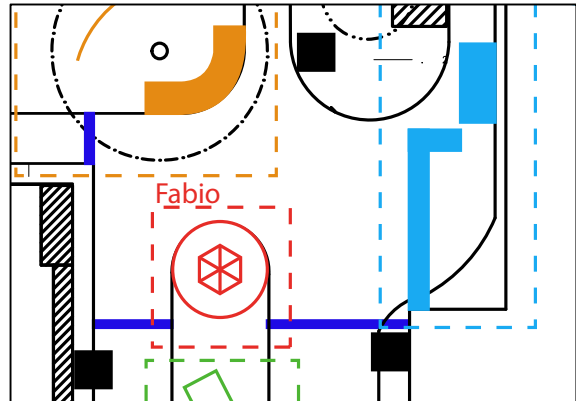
Ausschnitt aus dem Grundriss
